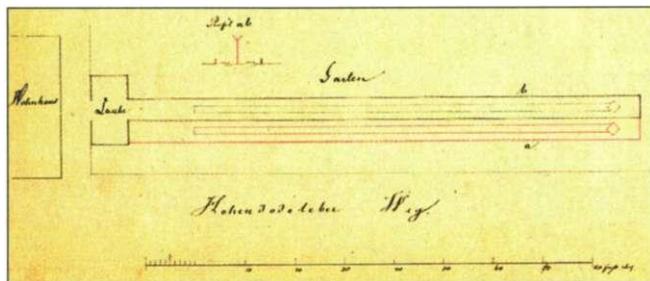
Liebknechtstraße 26, Situationszeichnung der Kegelbahn und eines älteren Wohnhauses 1846
